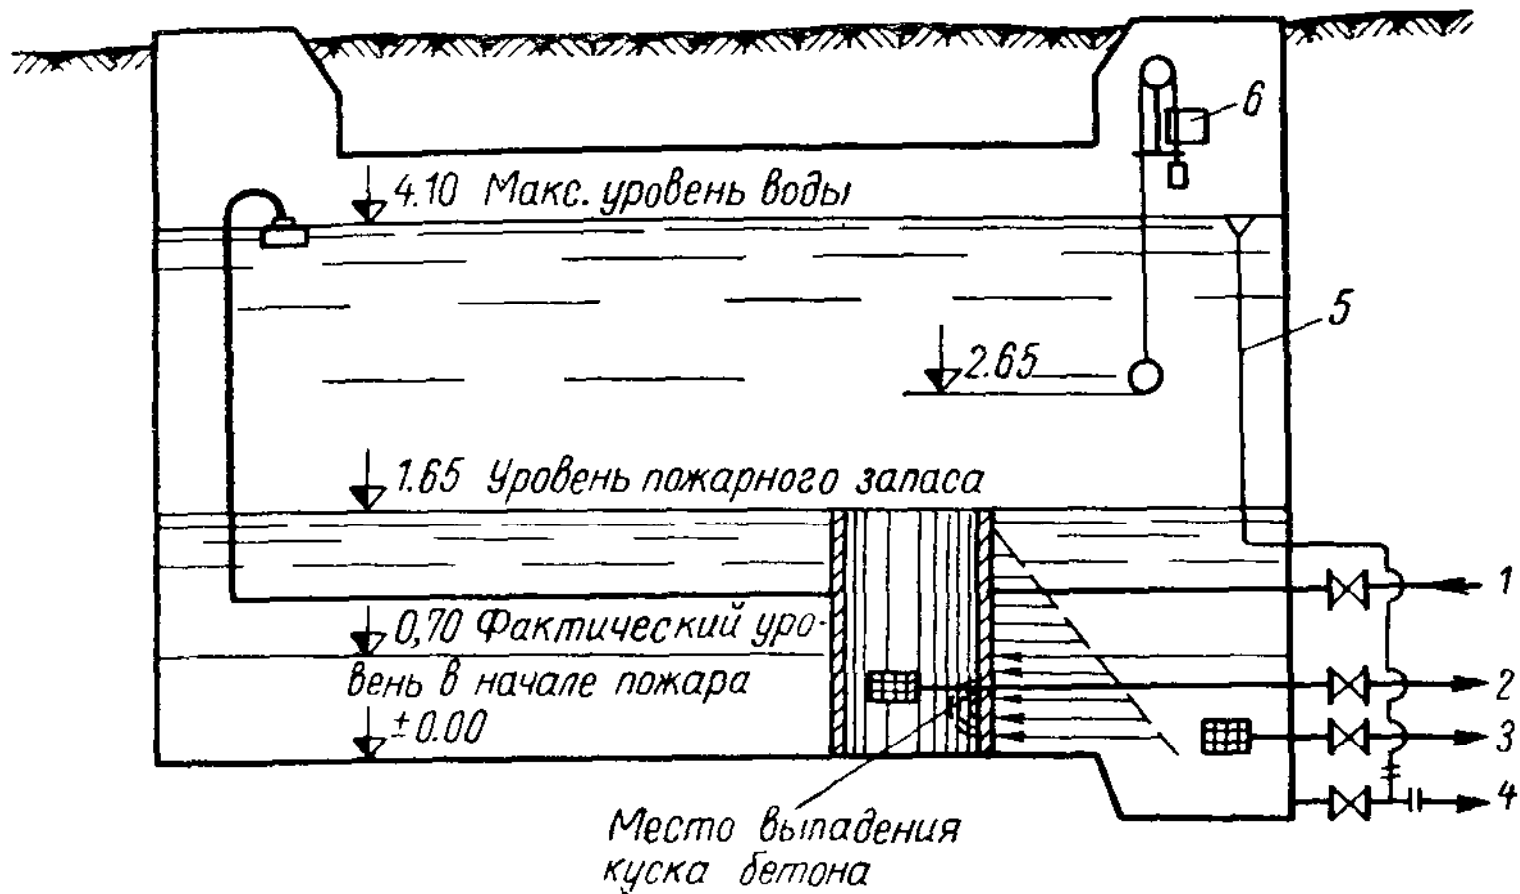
Схема сборного резервуара (к случаю с пожаром)
